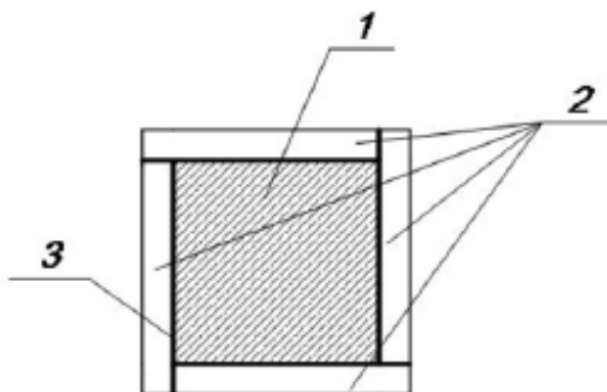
Железобетонная обойма, состоящая из сборных железобетонных плит и обмазка из жидкого стекла: 1 – железобетонная колонна, 2 – сборные железобетонные плиты, 3 – обмазка из жидкого стекла
